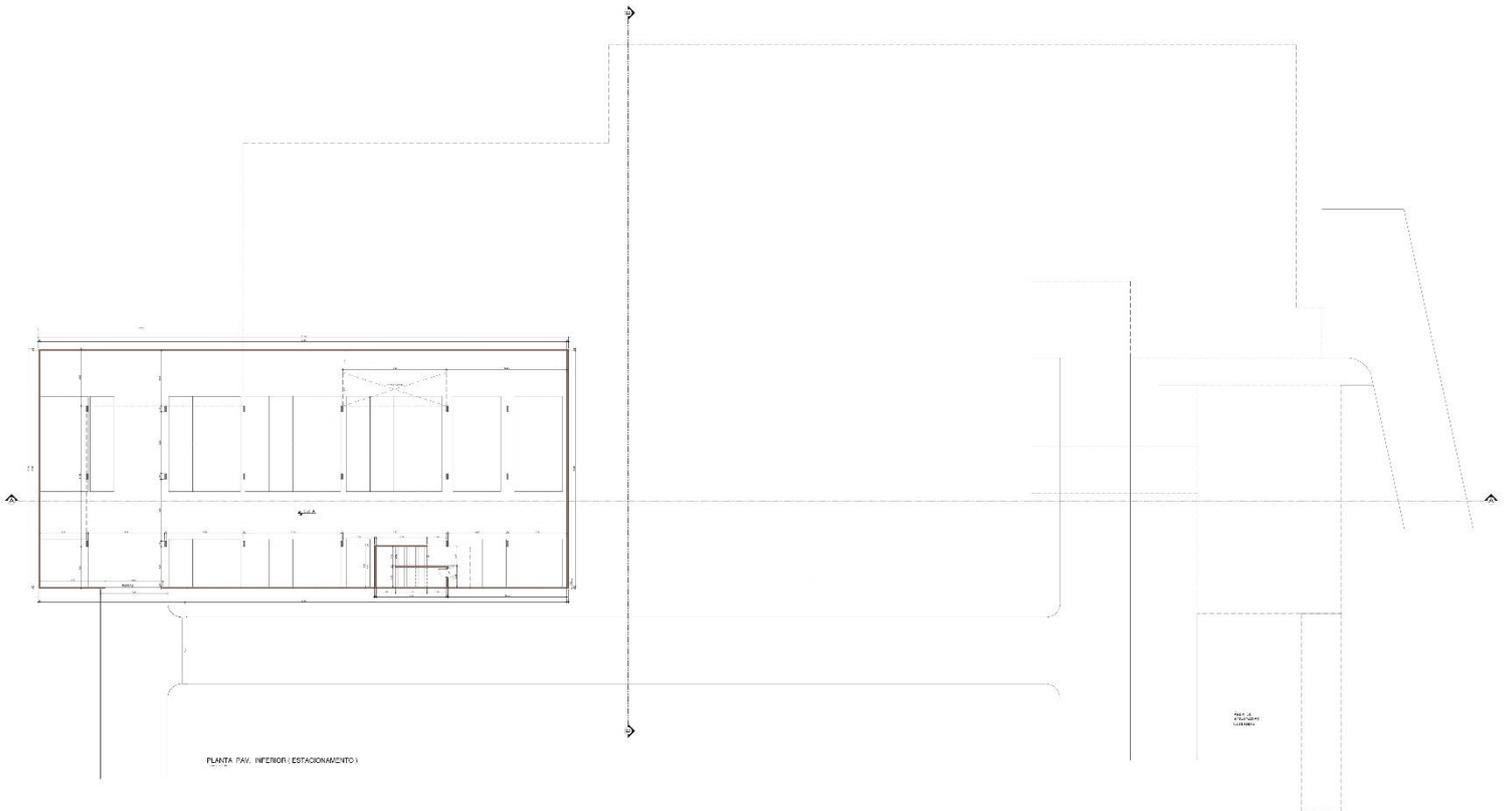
Projeto de implantação do empreendimento: pavimento inferior (estacionamento).
